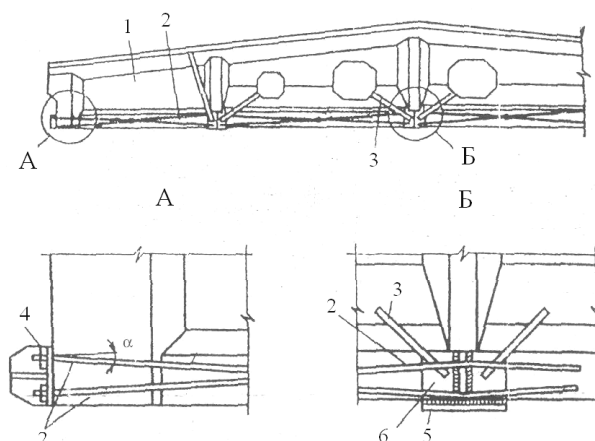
Усиление нижнего пояса стропильной балки с помощью круглой предварительно напряженной затяжки:
